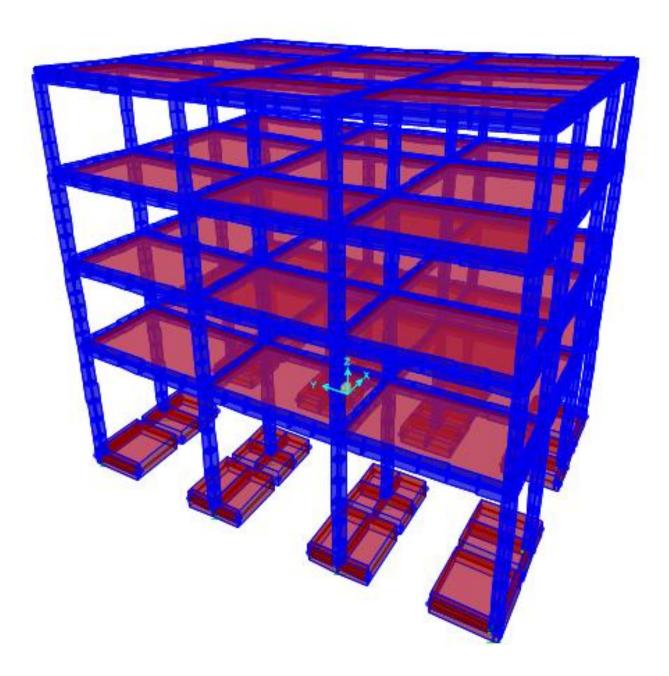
Asentamiento de la edificación-zapatas *Fuente*: Sap2000 v.18.2
